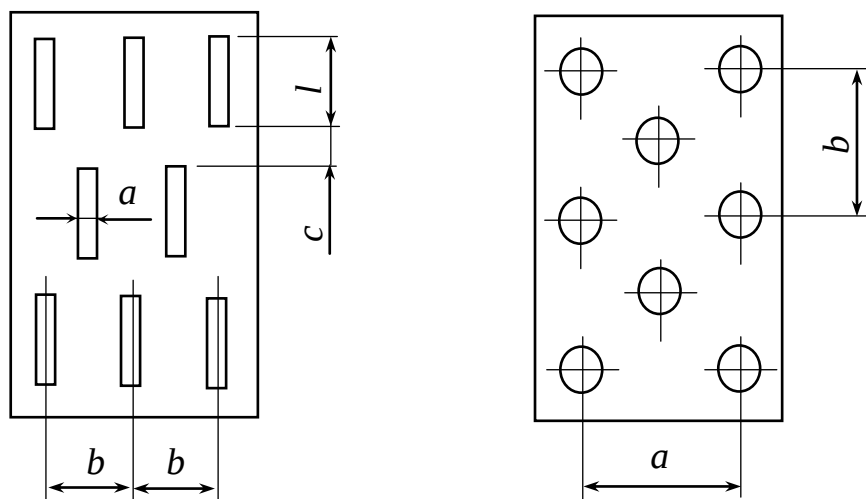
Разбивка прямоугольных щелей на корпусе водоприемника (а) и круглых отверстий на водосборном трубопроводе (б)
